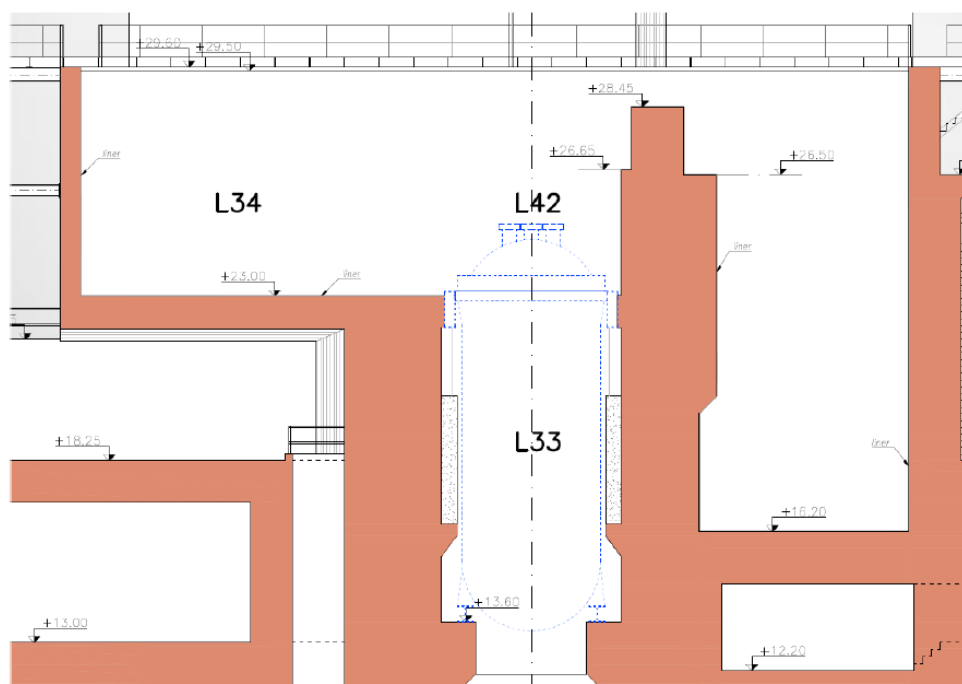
Sezione trasversale delle aree oggetto di intervento
